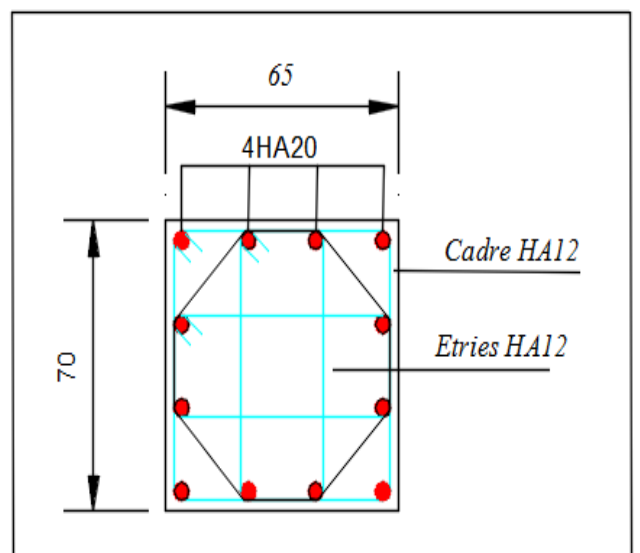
schéma de ferrailage des poteaux Entre sol et 1^{er} étage
